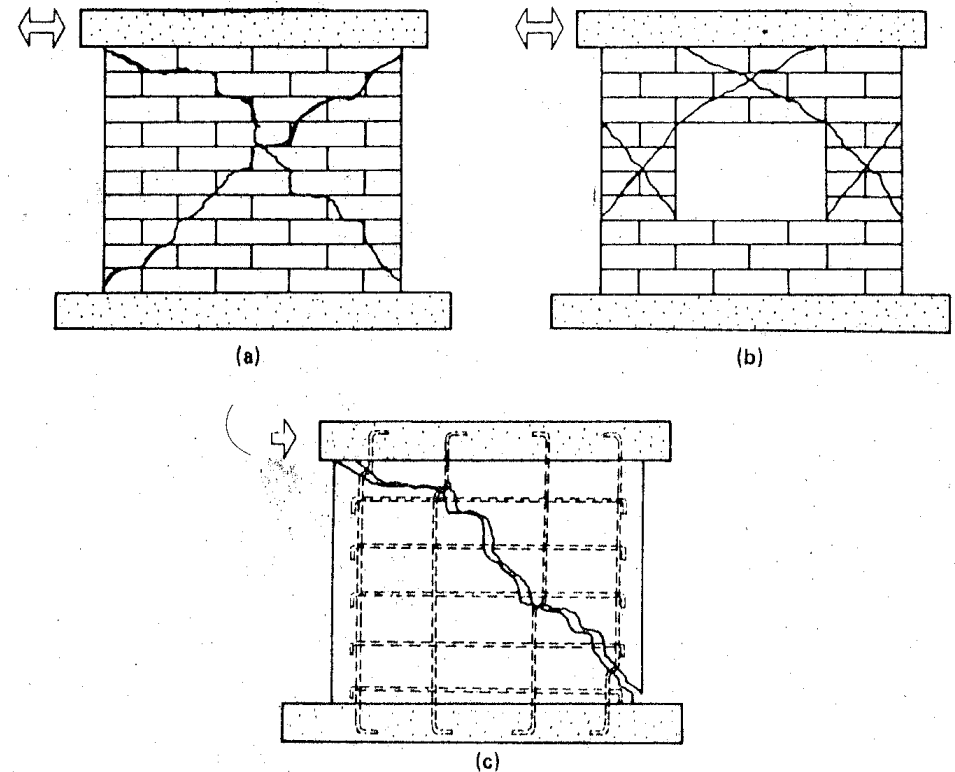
Grietas de cortante y refuerzo. (a) Muro de cortante. (b) Pilas y vigas. (c) Efectividad del refuerzo.
